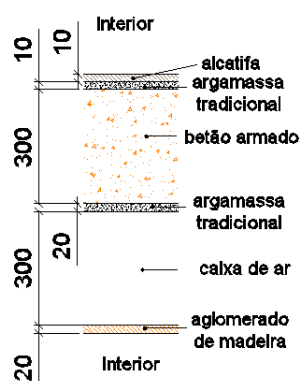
Pormenor do pavimento da envolvente interior – PAV2
